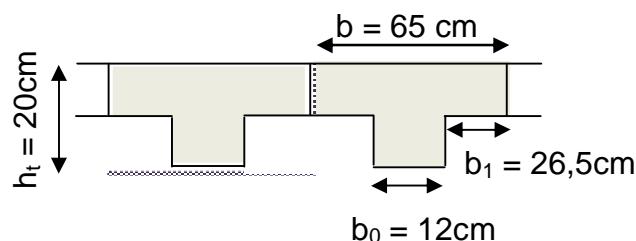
section de la poutrelle après coulage de la dalle de compression
